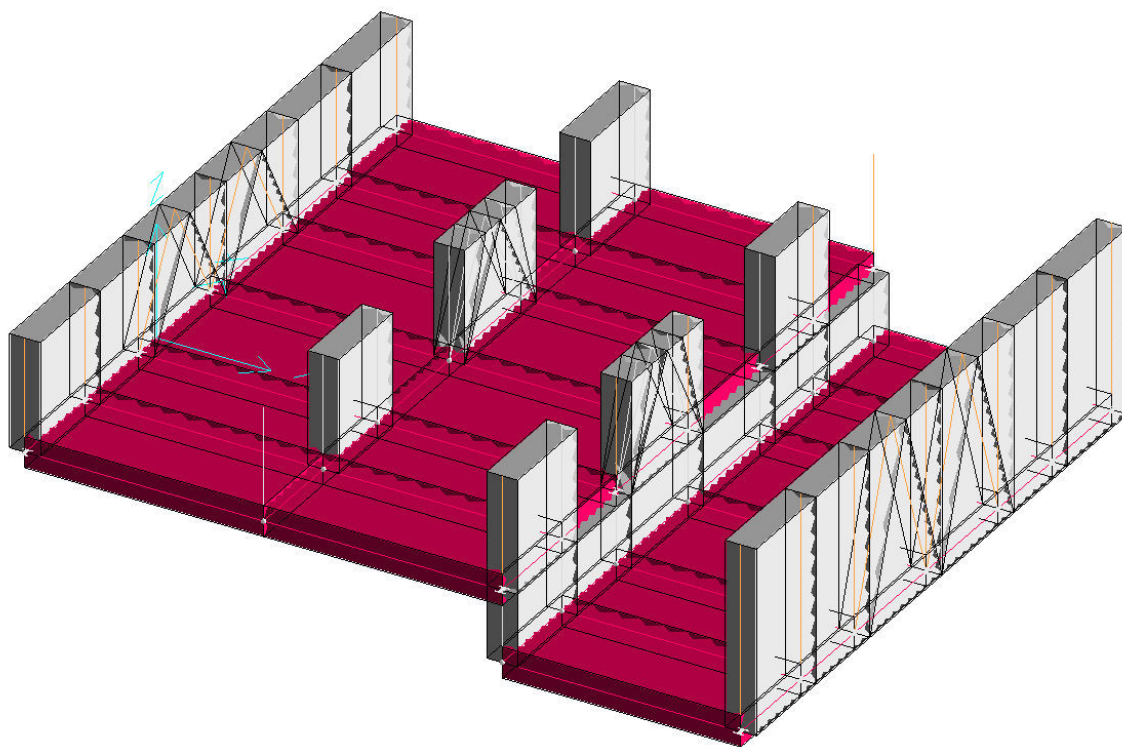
immagine della vasca di laminazione in progetto – privata della soletta superiore – al fine di evidenziare la posizione sfalsata dei setti verticali
